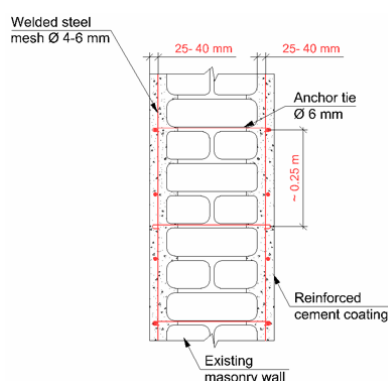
Intervenção em ambos os lados da parede. Pregagens transversais afastadas 0.25 m
